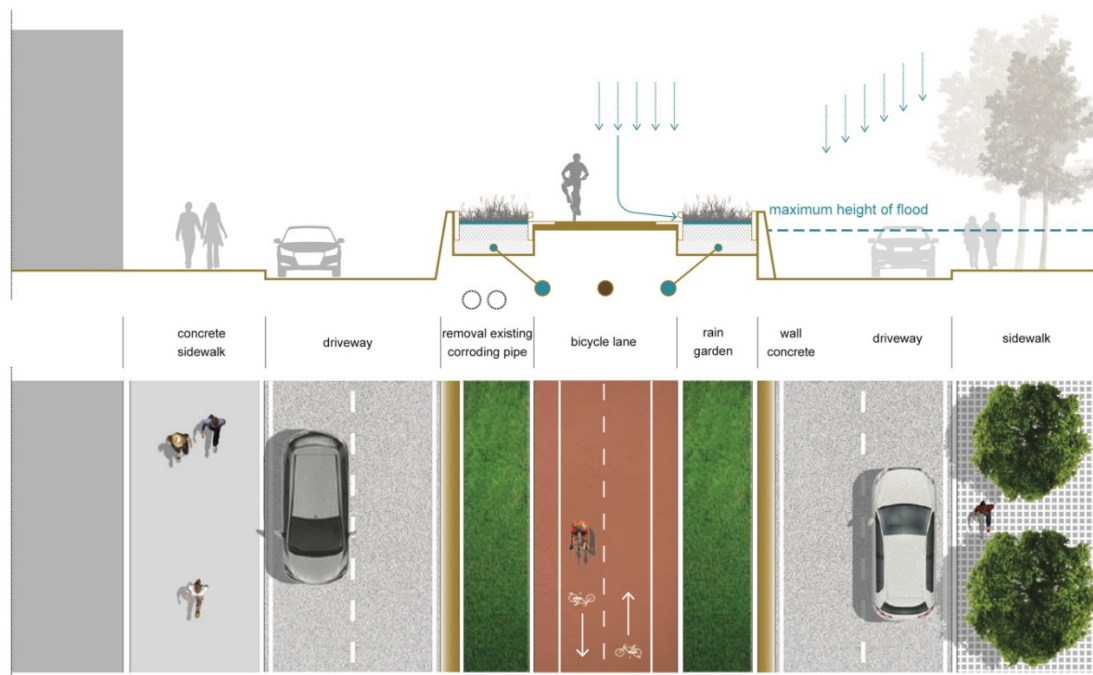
| San Rafael sezione e planimetria di Canal Street.
